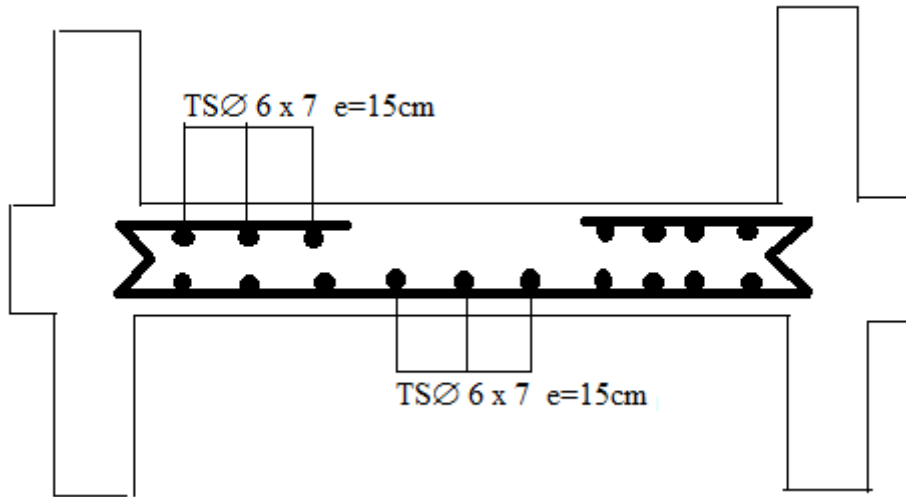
Schéma du ferrailage de la dalle plancher terrasse.
